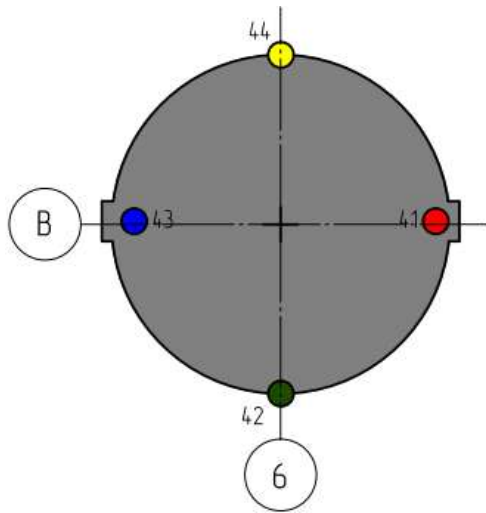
Схема встановлення деформаційних марок № 41 – № 44 на фундаменті силосу для зберігання зерна 10.1
